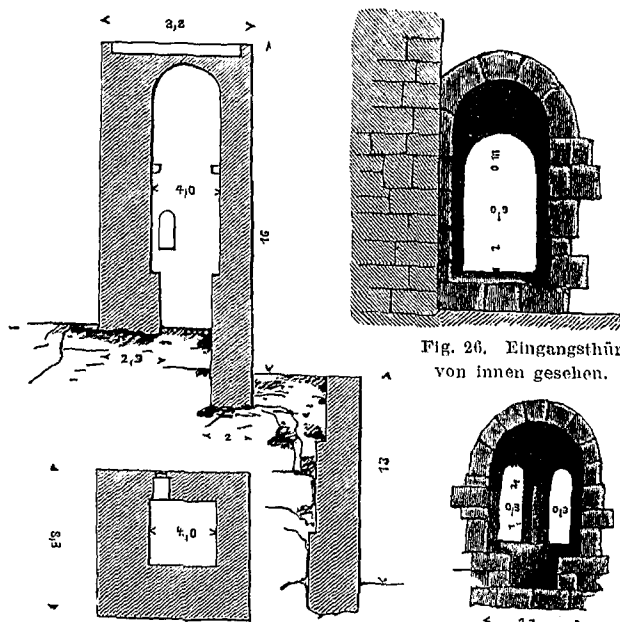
u. 25. Grundriss und Schnitt.
